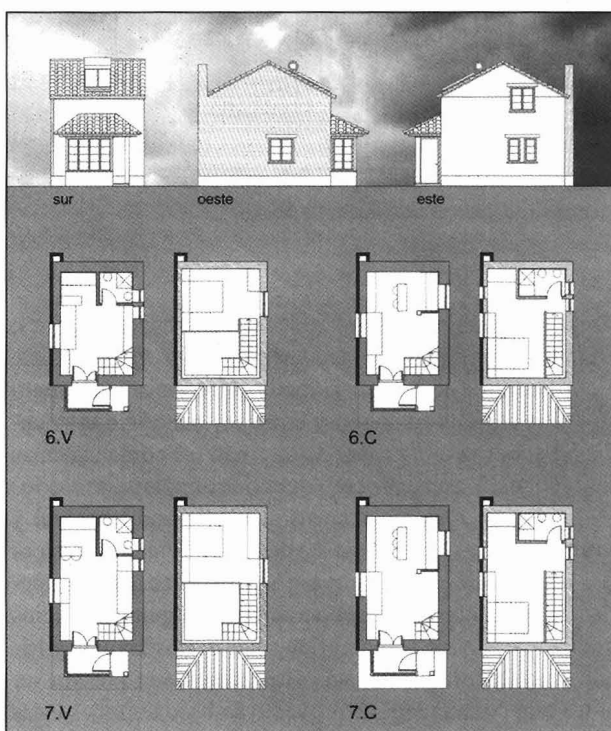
Plantas y Alzados. Cuatro tipos de viviendas en función de las distribuciones interiores.
